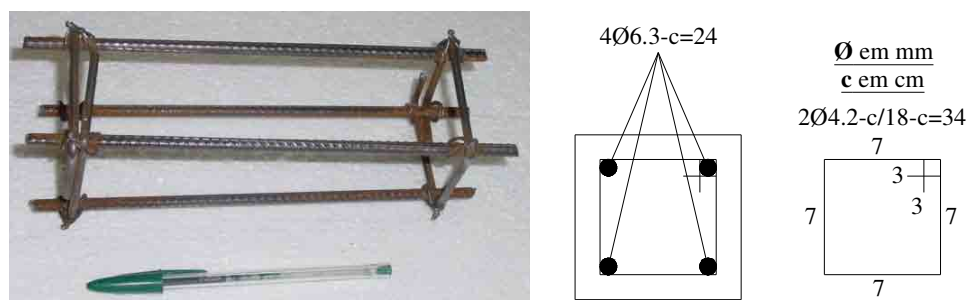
Armadura e detalhamento utilizada nos corpos-de-prova
